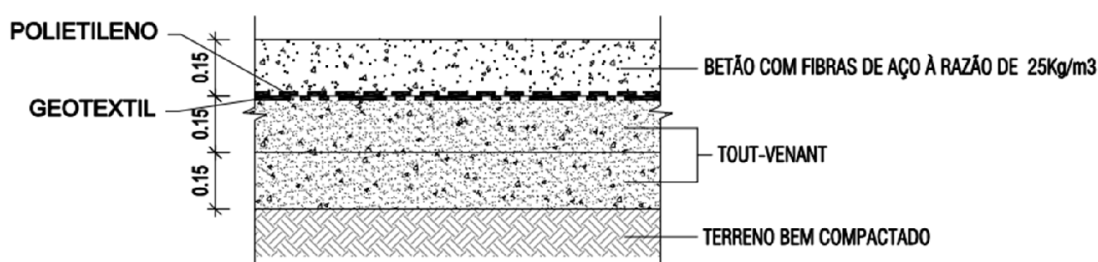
Pormenor da laje de piso térreo (Marques, 2011).
